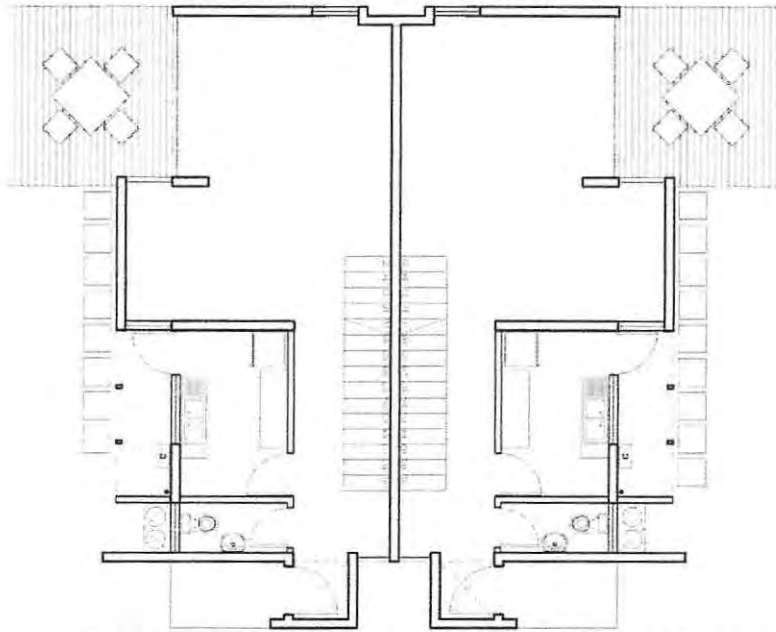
Planta arquitectura primer piso vivienda pareada [21]
